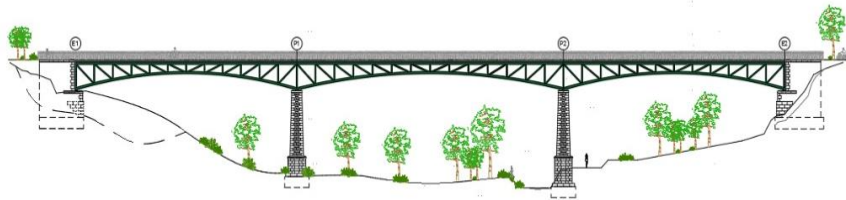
Solución 3.1 de pasarela. (Fuente: elaboración propia AutoCAD)
